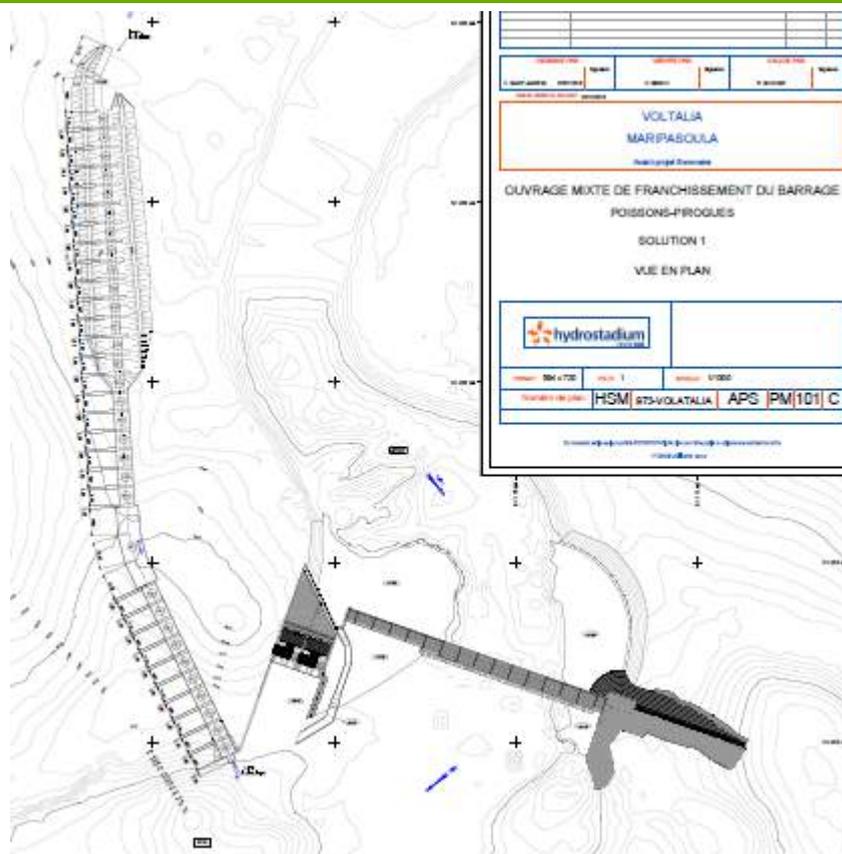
Vue en plan de la passe mixte poissons-pirogues (hydrostadium, 2016)
